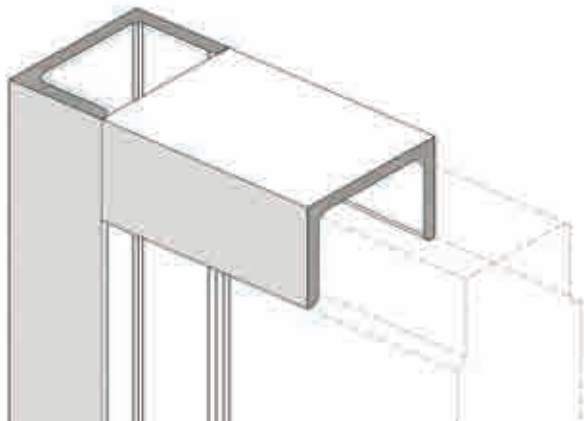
Unión entre los perfiles perimetrales exteriores del panel
